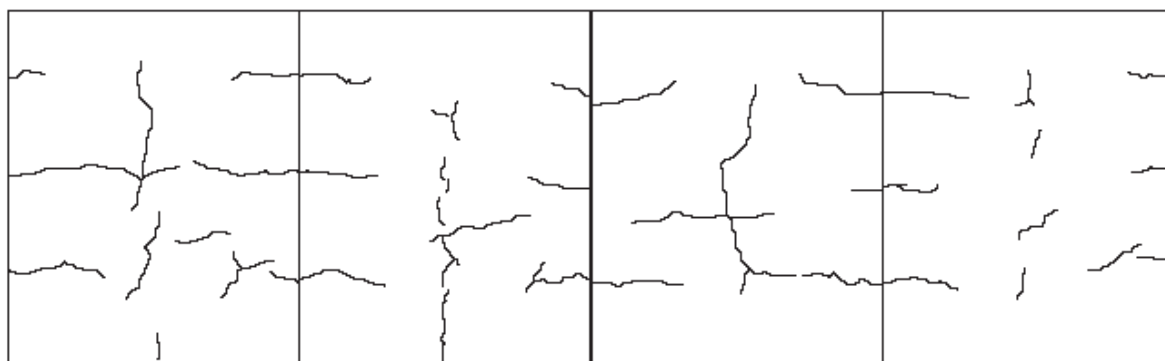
冬期打設の試験体表面のひび割れ（丸山）
